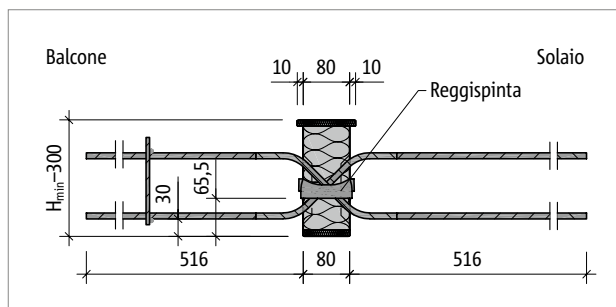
Schöck Isokorb® T tipo QL-VV4: sezione del prodotto
